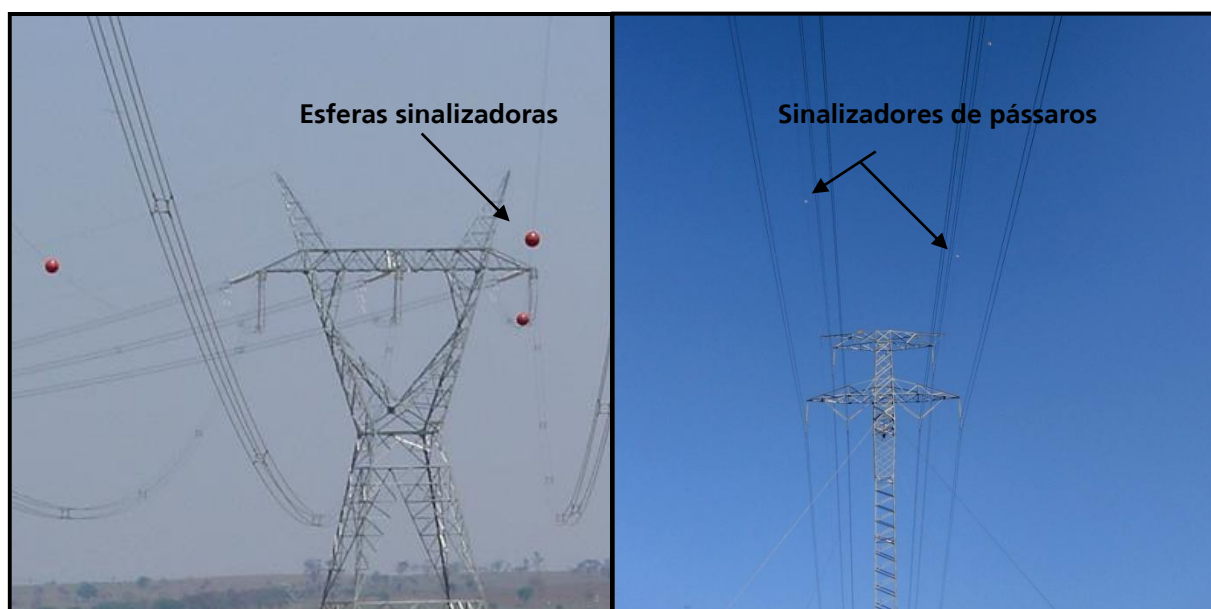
Locais de instalação de sinalizadores entre as torres 246/2 a 251/1.
